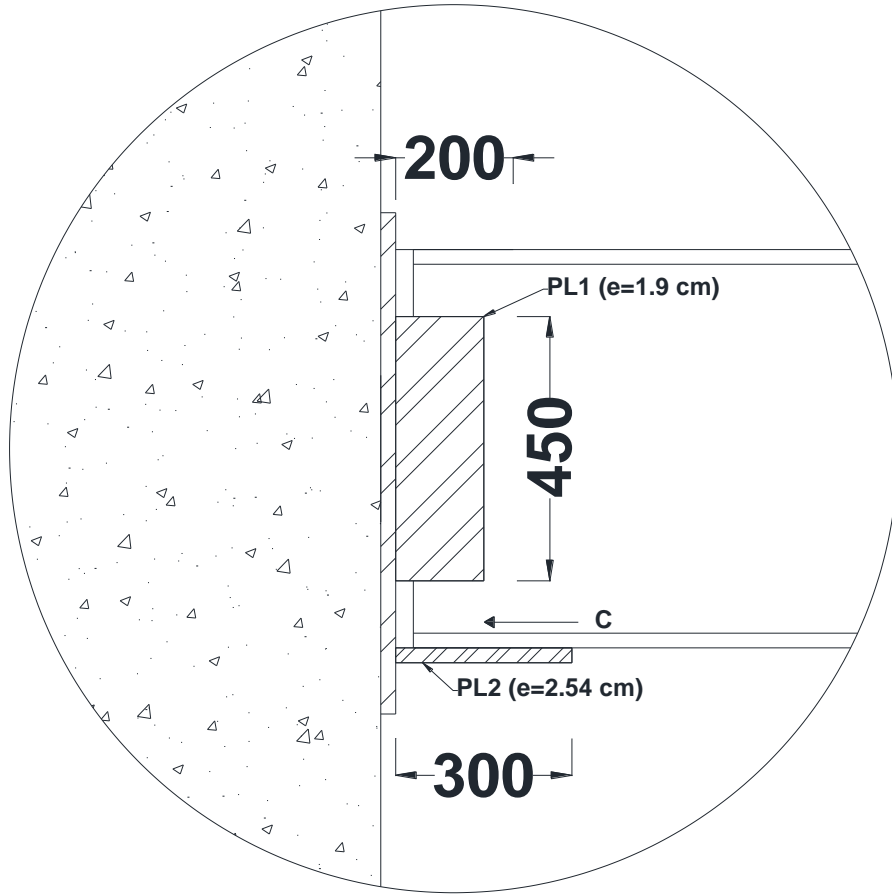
Conexión soldada, dimensiones en mm.
